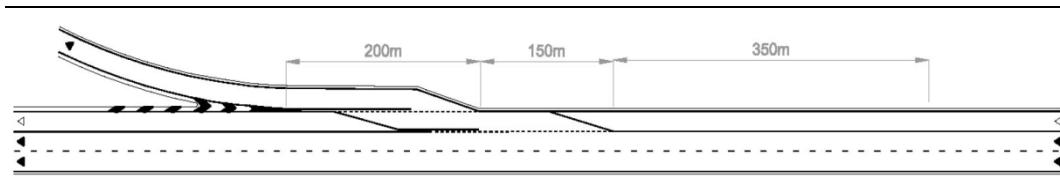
Markierung einer Ausfahrt bei durchgehender temporären PUN über den Anschluss hinweg (PUN-Typ 2).
